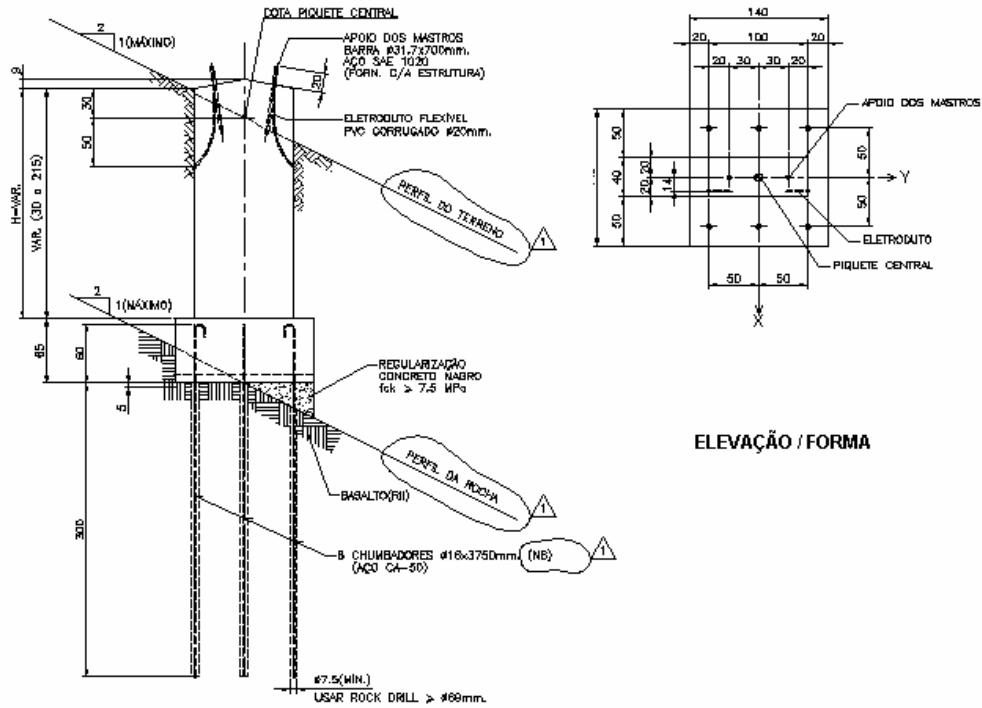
Fundação em bloco ancorado para o mastro de torre estaiada de suspensão na LT Salto Santiago-Cascavel Oeste.
